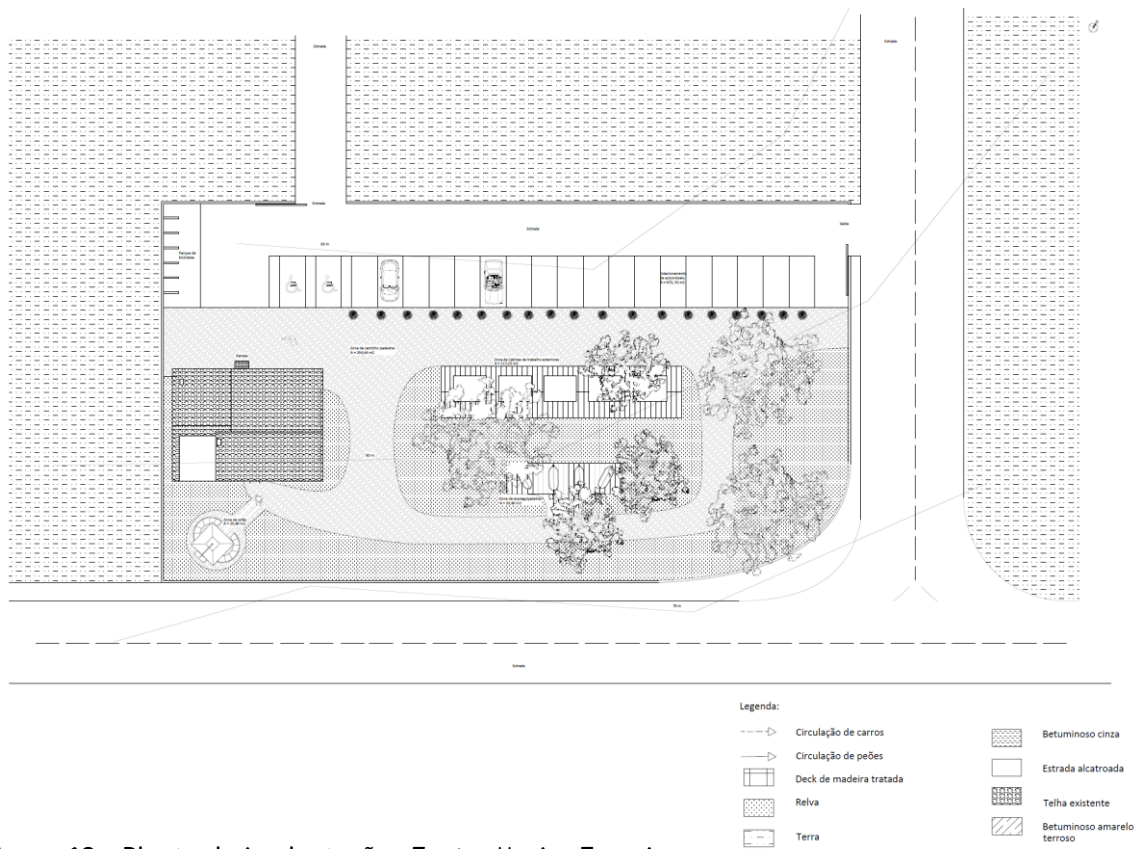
Planta de implantação. Fonte: Marisa Francisco.
